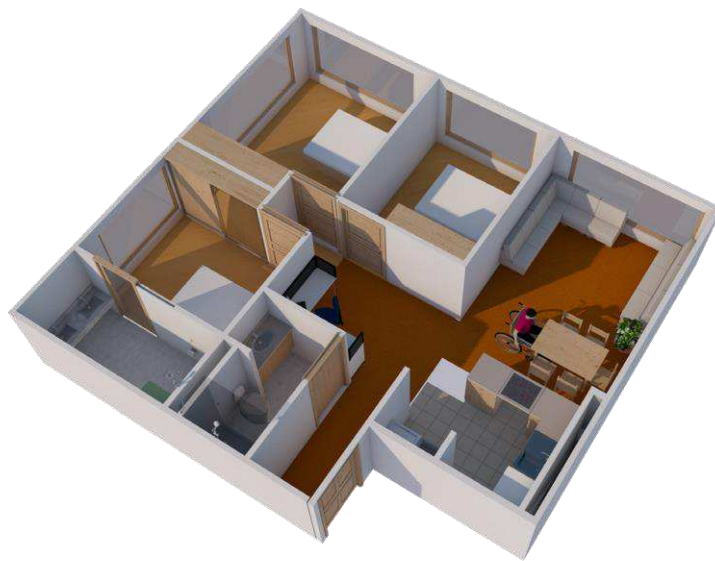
Planta tipo N.4, Vista 3D, agrupación, planta técnica. Autor.
